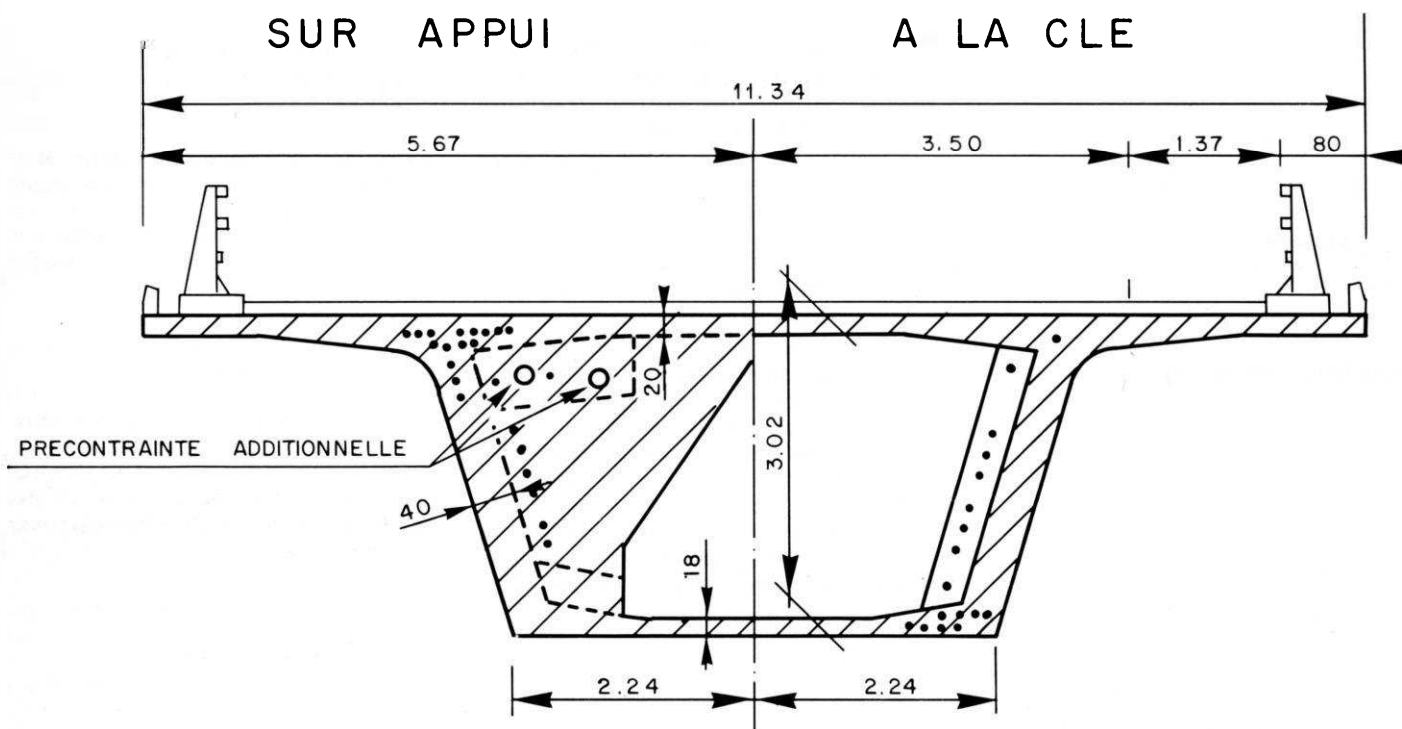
Viaduc des Neyrolles - Coupe transversale du tablier.
